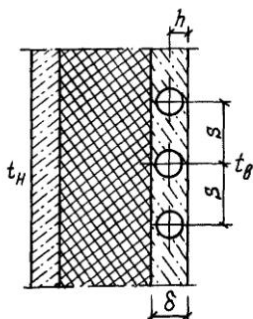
Размещение нагревательных элементов в наружной стеновой панели
